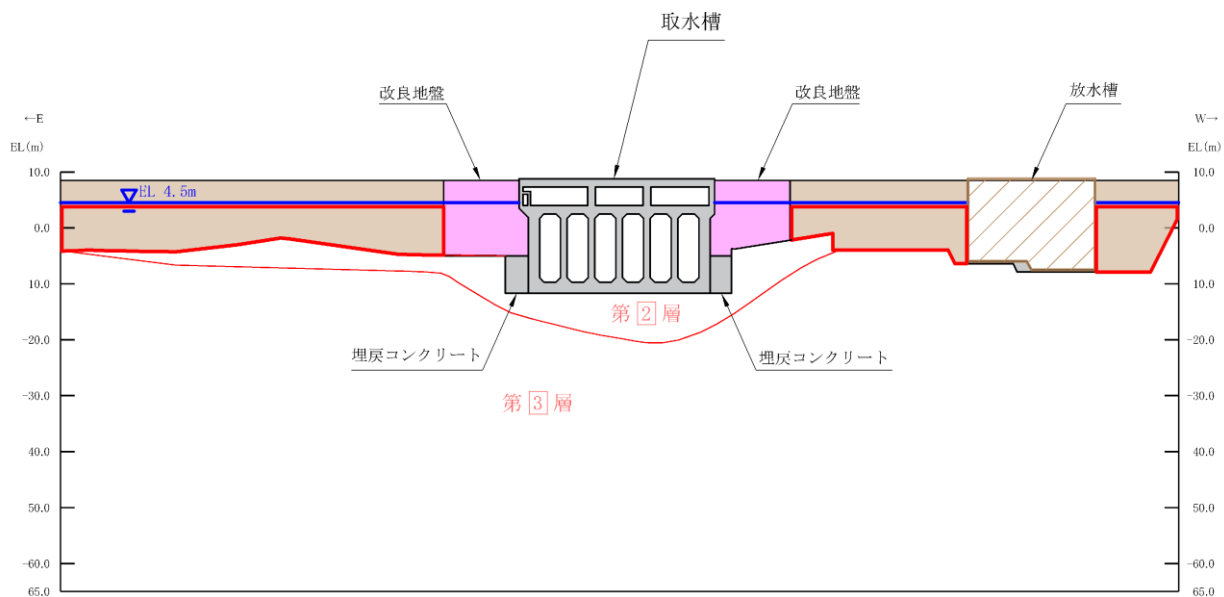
取水槽 地震時荷重算出断面図 (A-A 断面)
